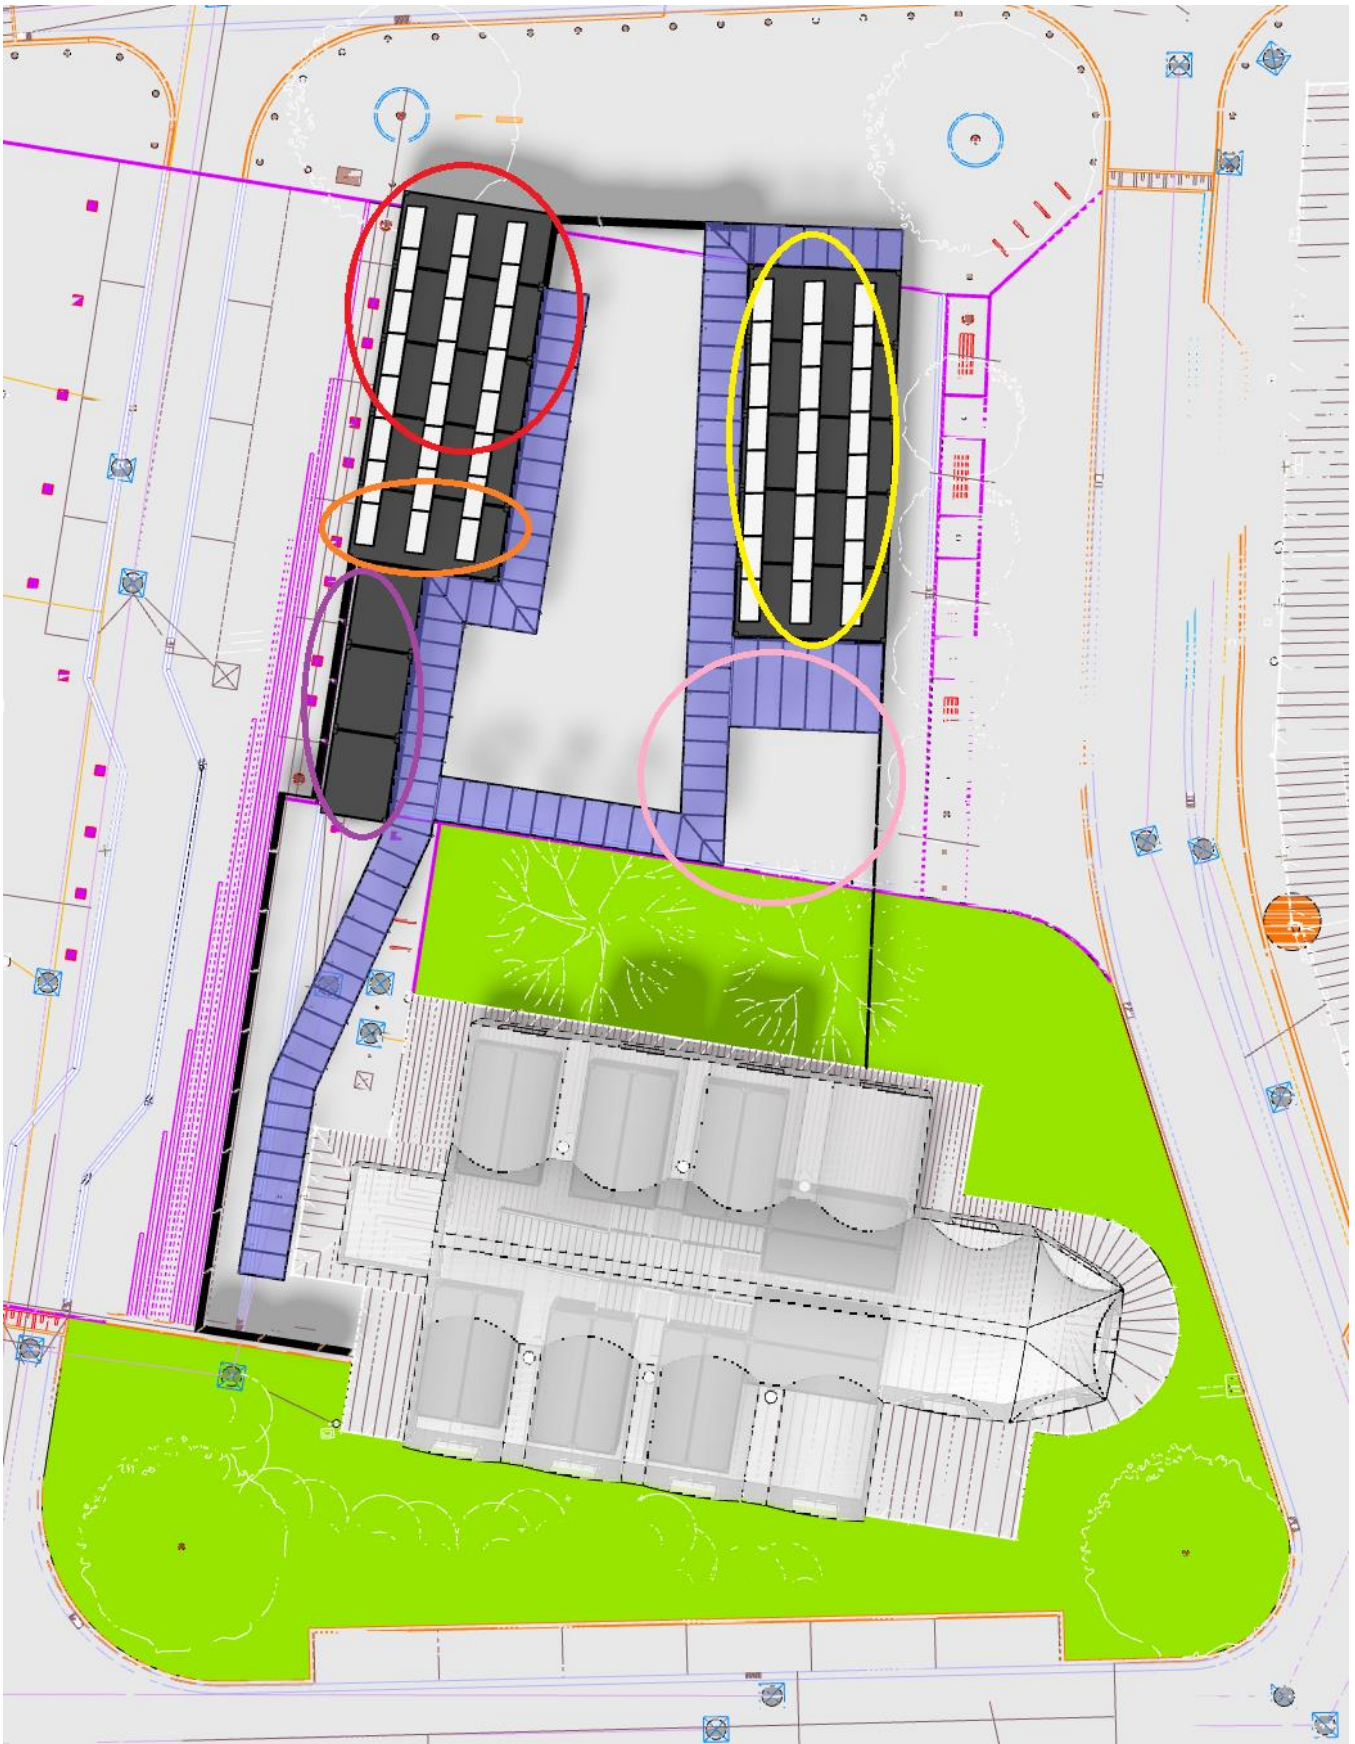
Plan d'implantation de la proposition de centre d'hébergement
